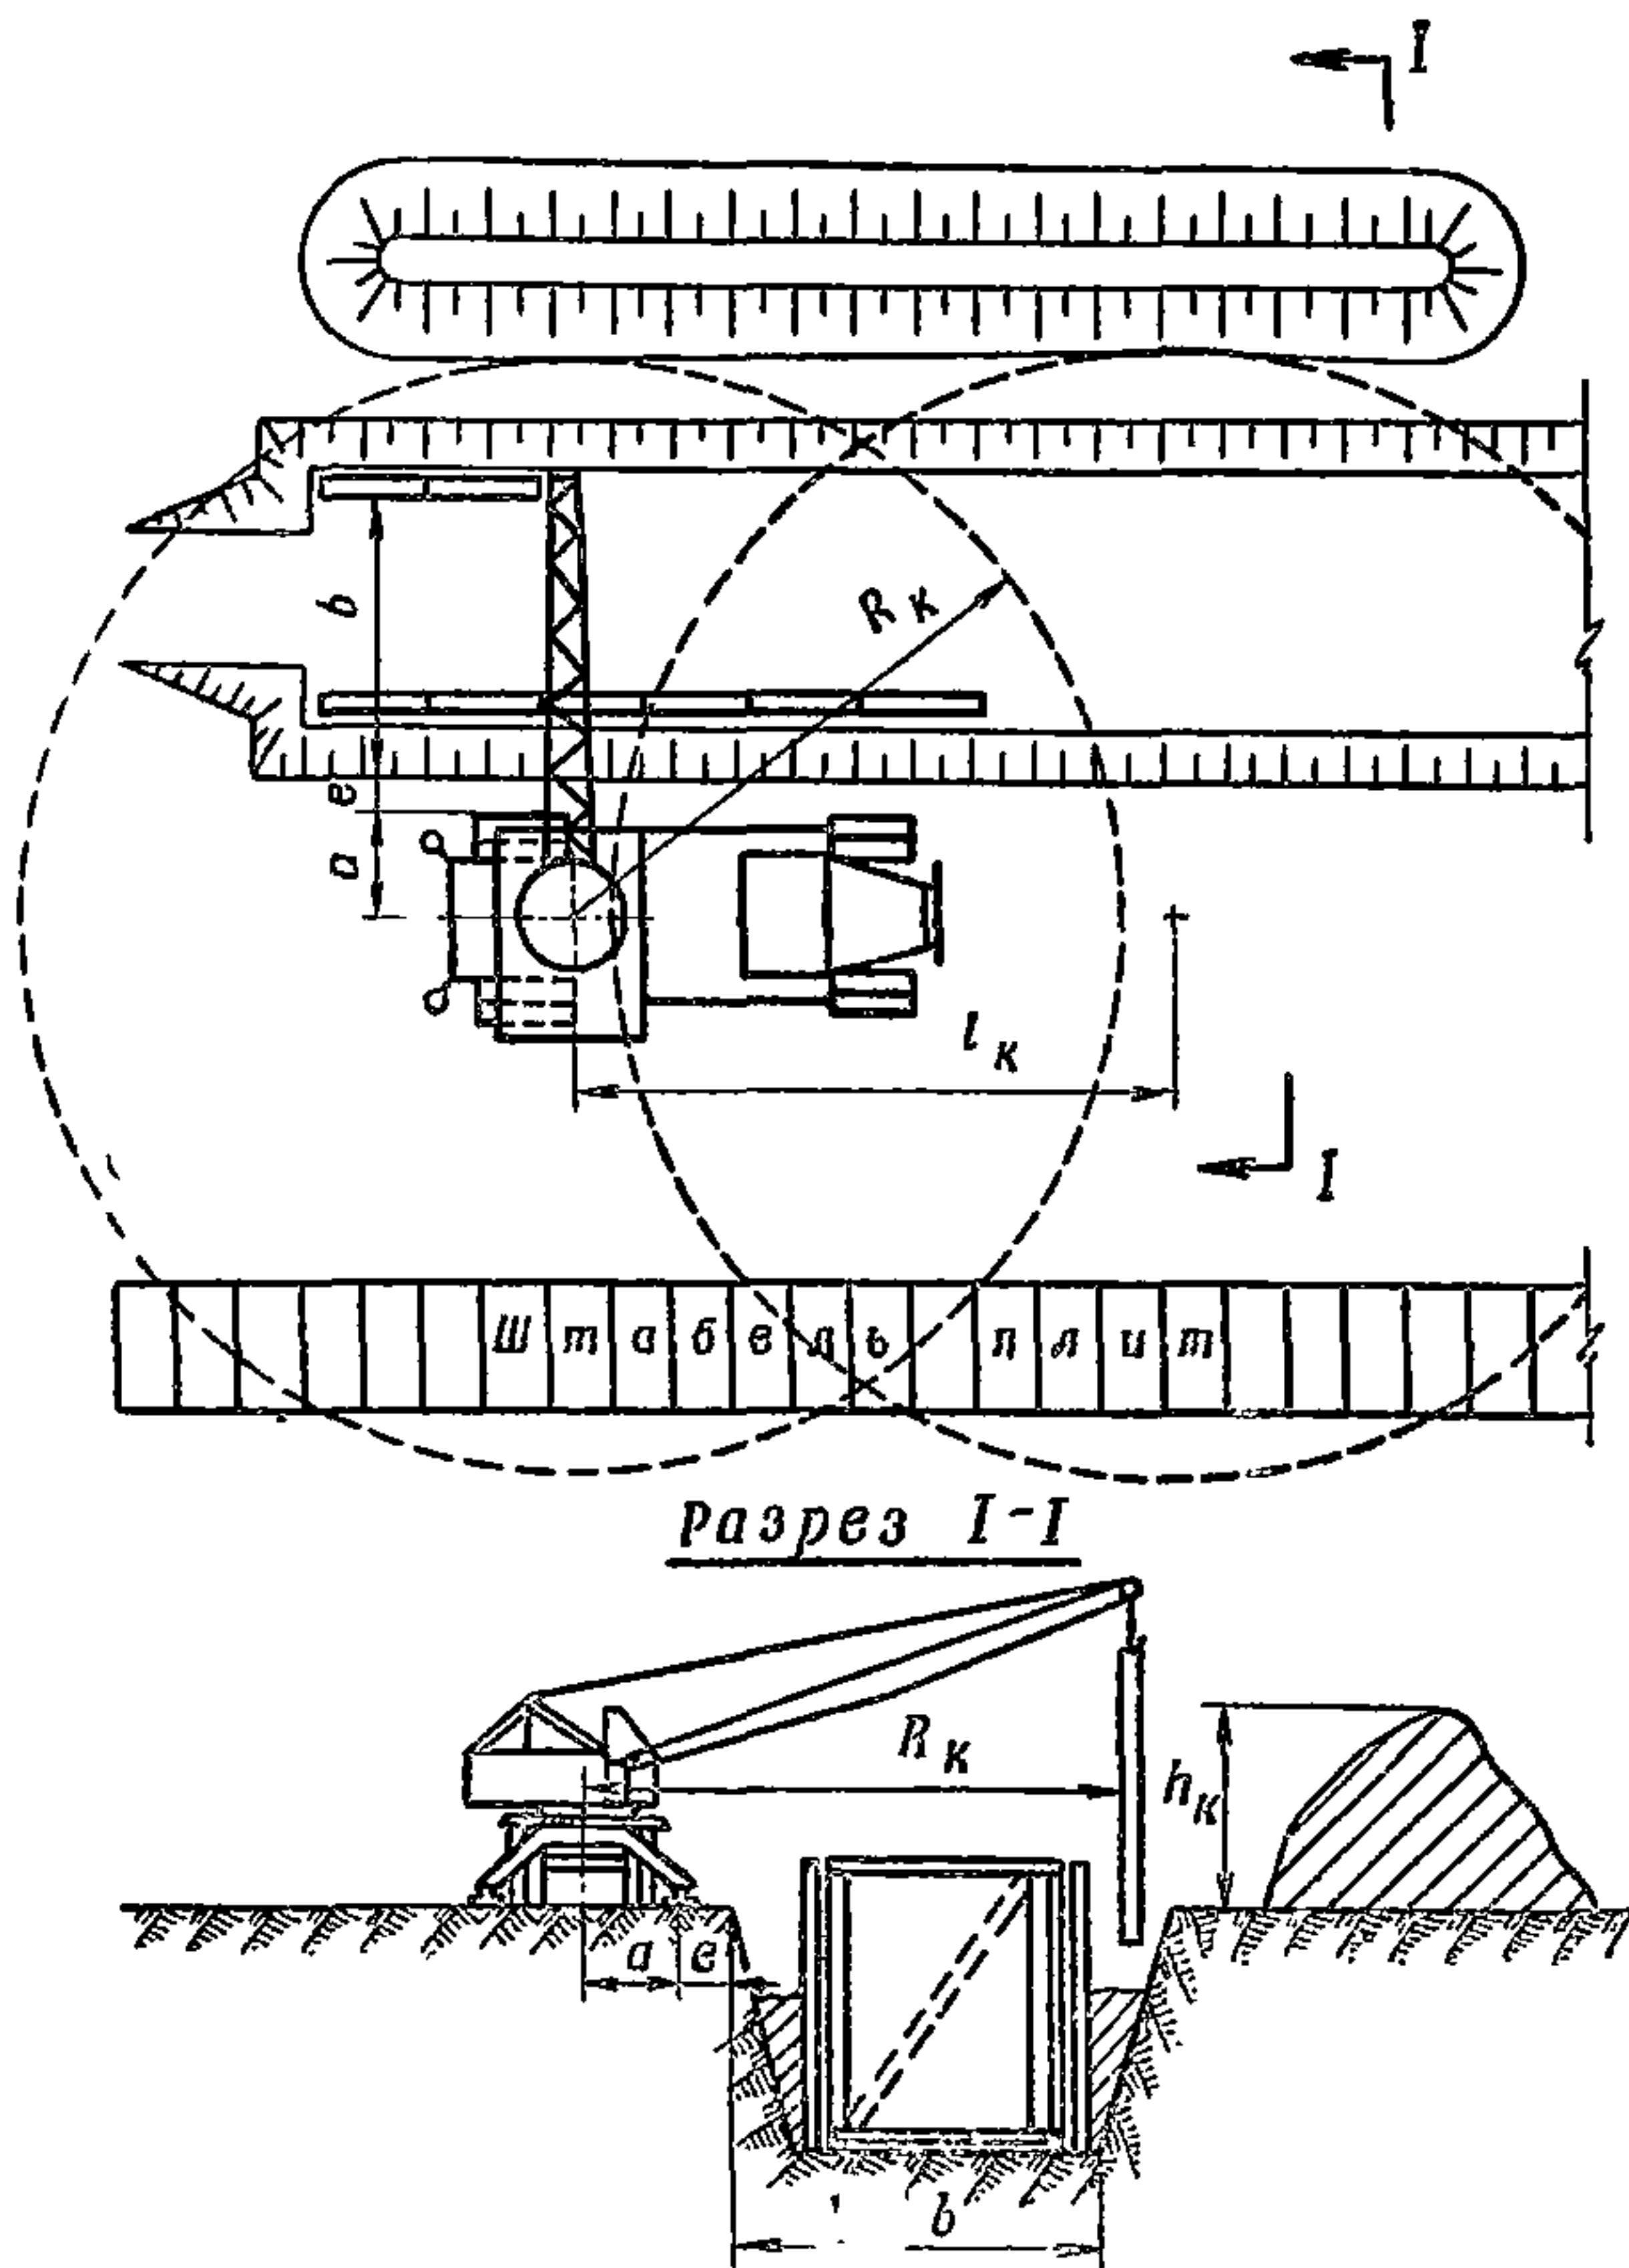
Схема производства работ по монтажу стен из железобетонных плит (панелей) с помощью крана:
